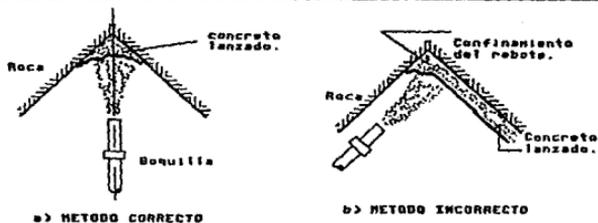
APLICACION DE CONCRETO LANZADO EN ESQUINAS INTERIORES.
